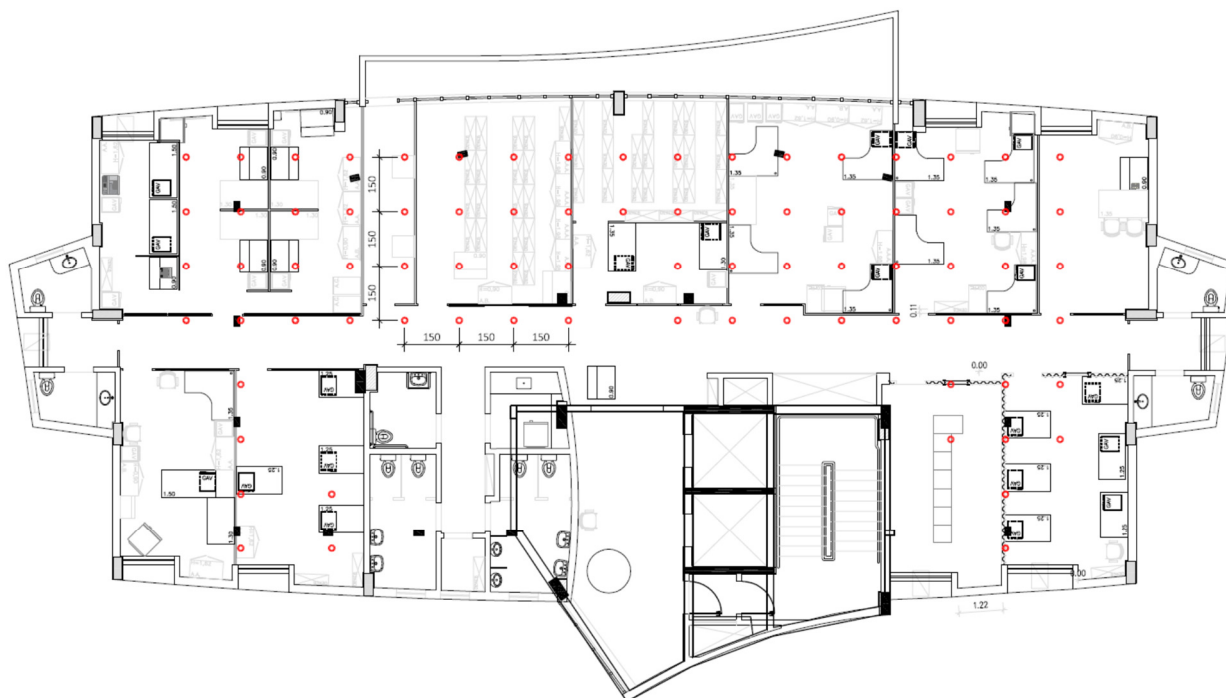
Croquis Esquemático de disposição das torres nos pavimentos térreo e subsolo
